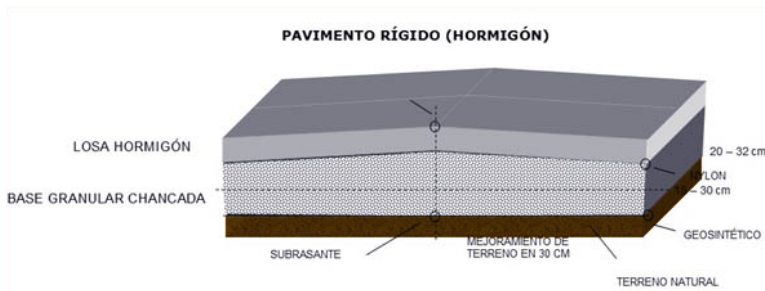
Composición de un pavimento de concreto hidraulico o pavimento rígido.
